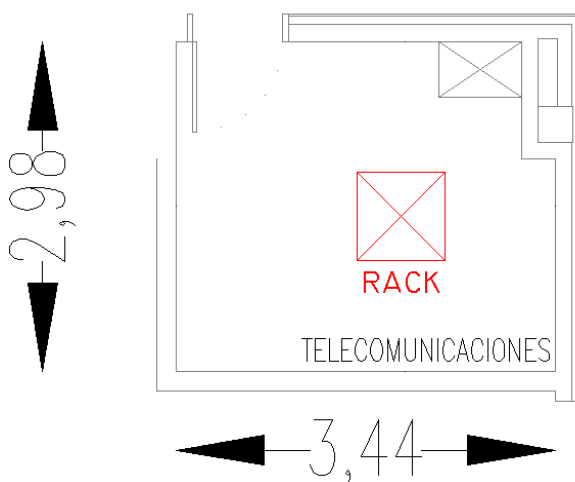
dimensiones del cuarto en la planta baja del edificio
